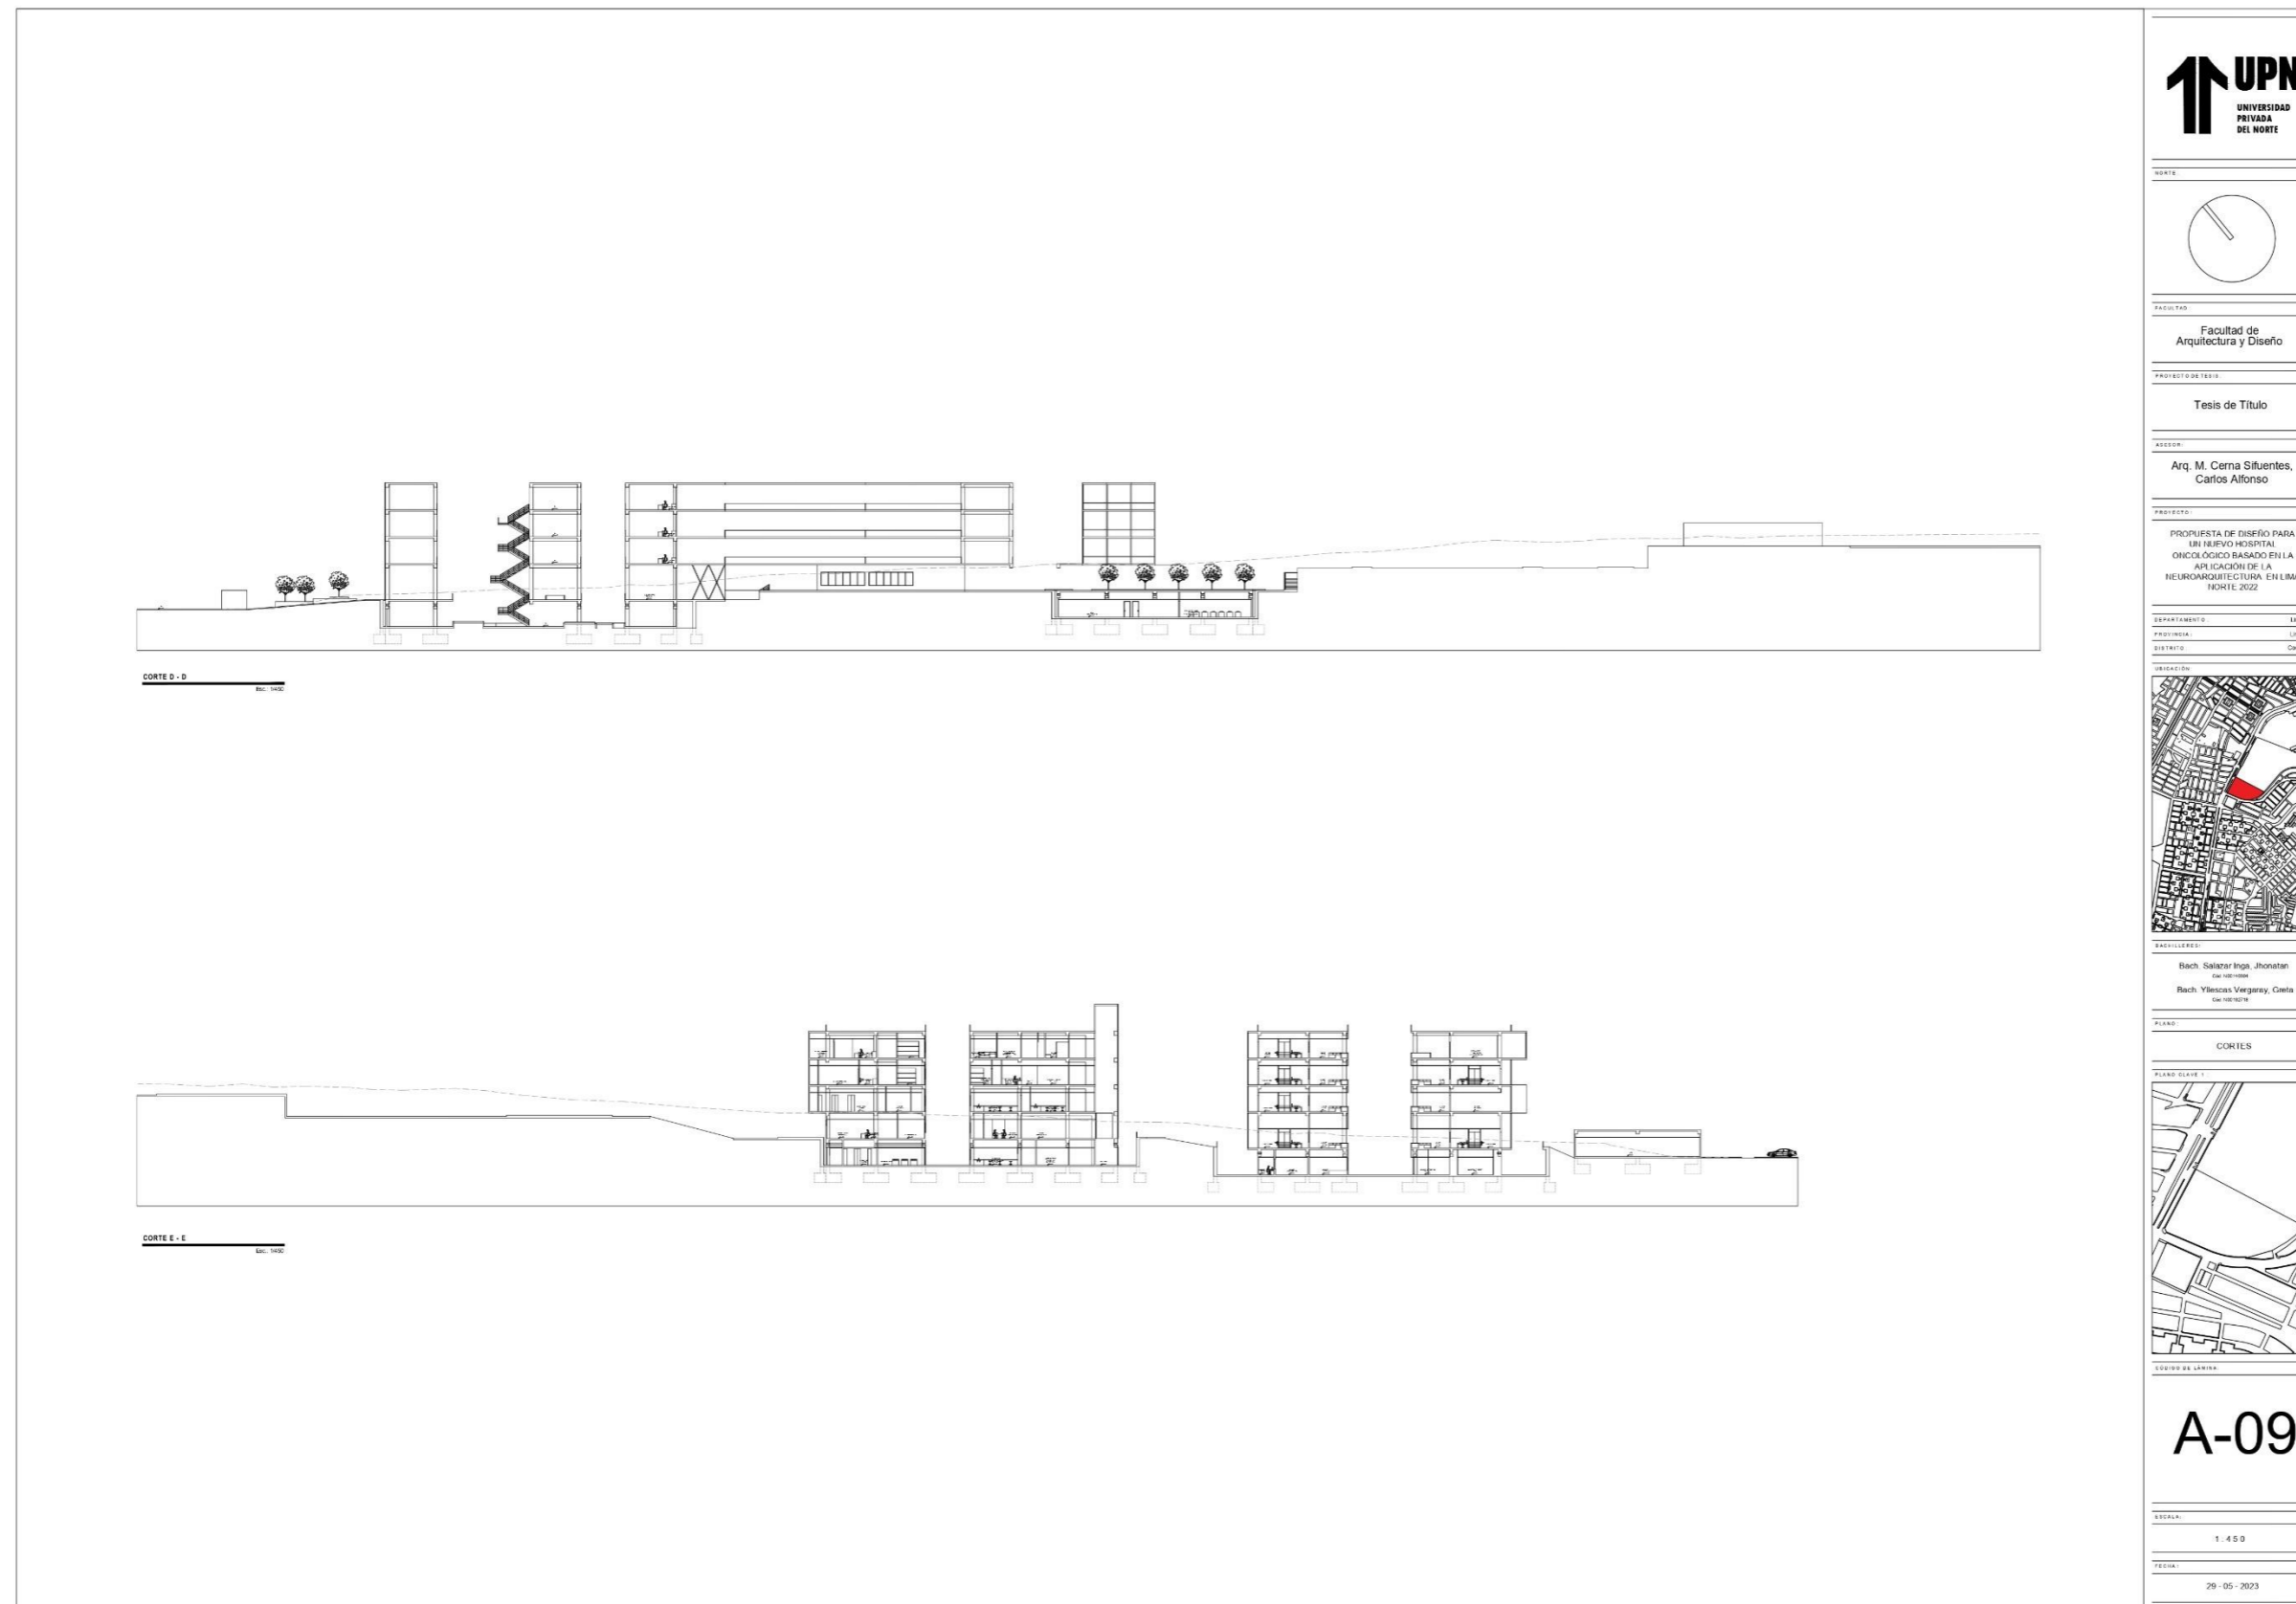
Arquitectura – Cortes N°2 Esc: 1/450 (Fuente: Elaboración propia de los coautores)
